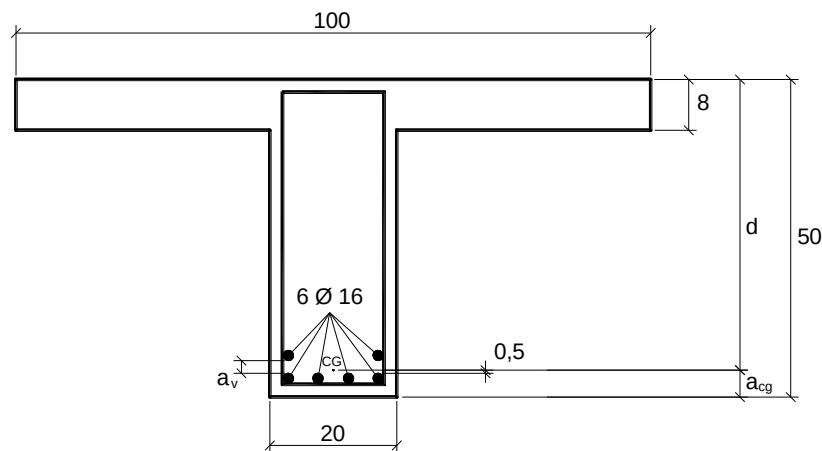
Detalhamento da armadura longitudinal na seção transversal.
